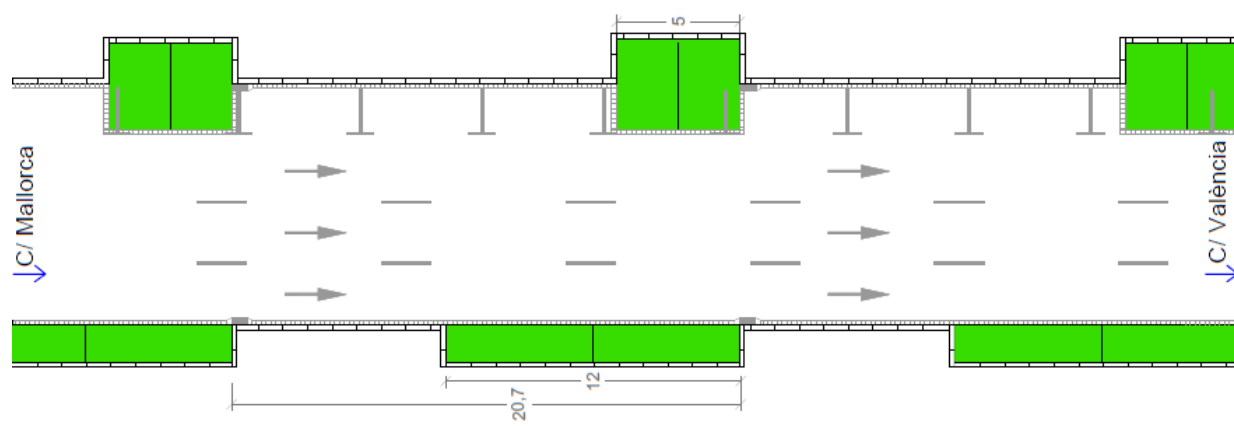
Planta de la propuesta para la C/ Lepanto, caso b) (Tipo 2).
